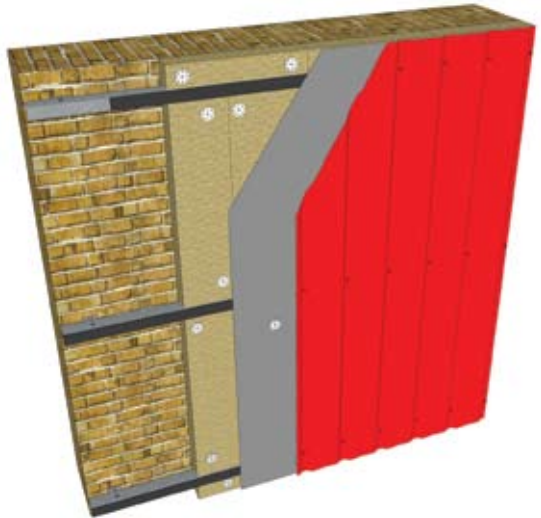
Вентильований фасад з утепленням. Облицювальний матеріал — стіновий профнастил
